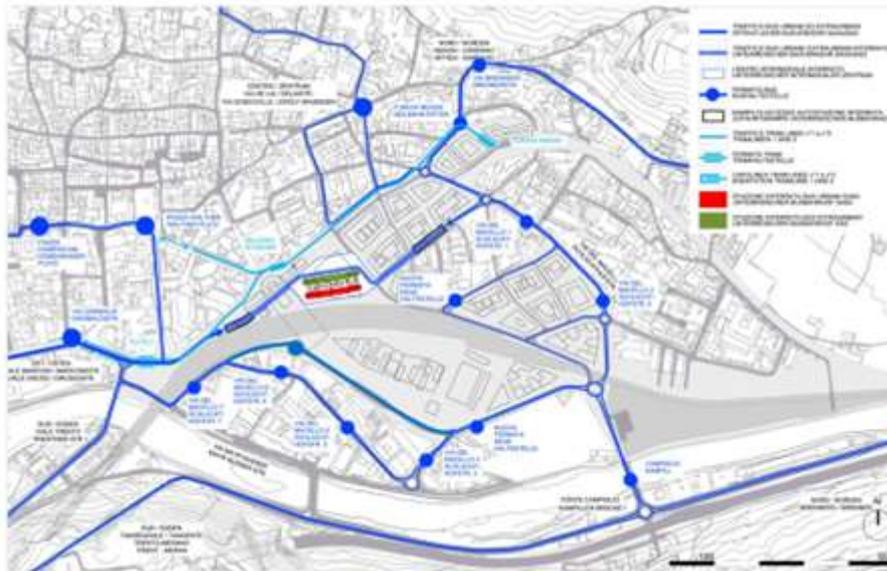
Viabilità pubblica di progetto estratto dal Masterplan
